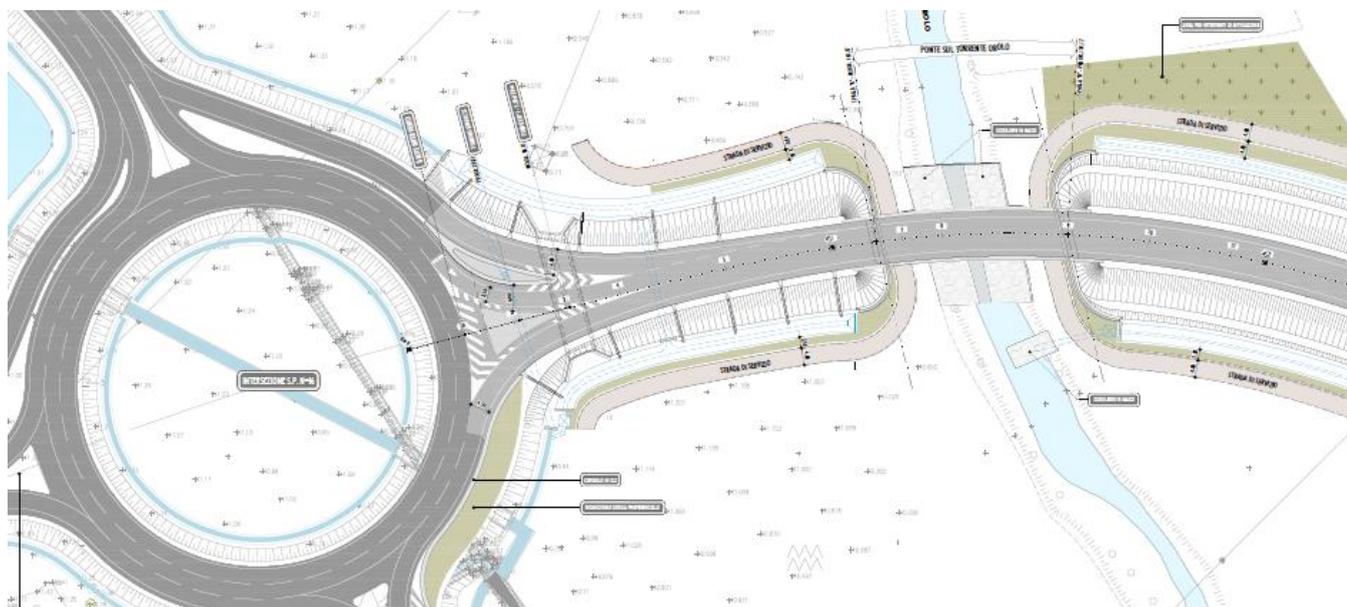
Completamento S.P. n° 46 – stralcio planimetrico
